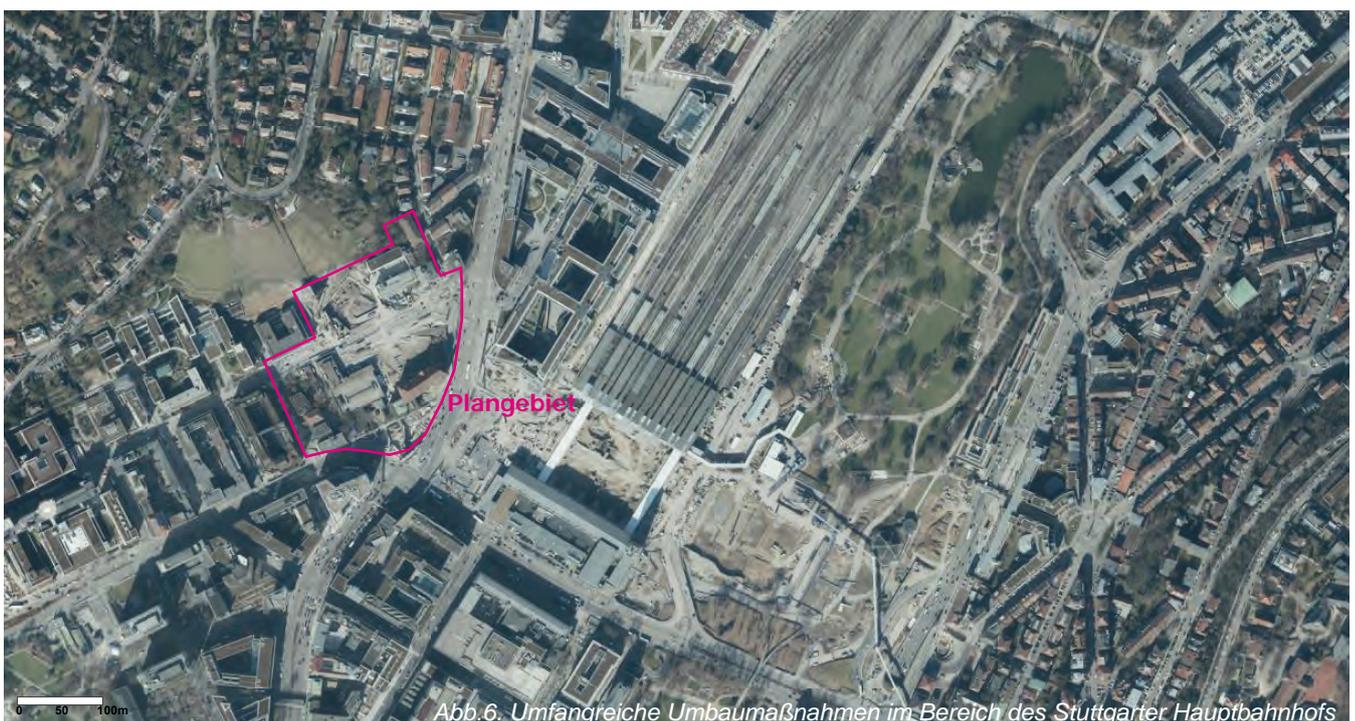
Umfangreiche Umbaumaßnahmen im Bereich des Stuttgarter Hauptbahnhofs
